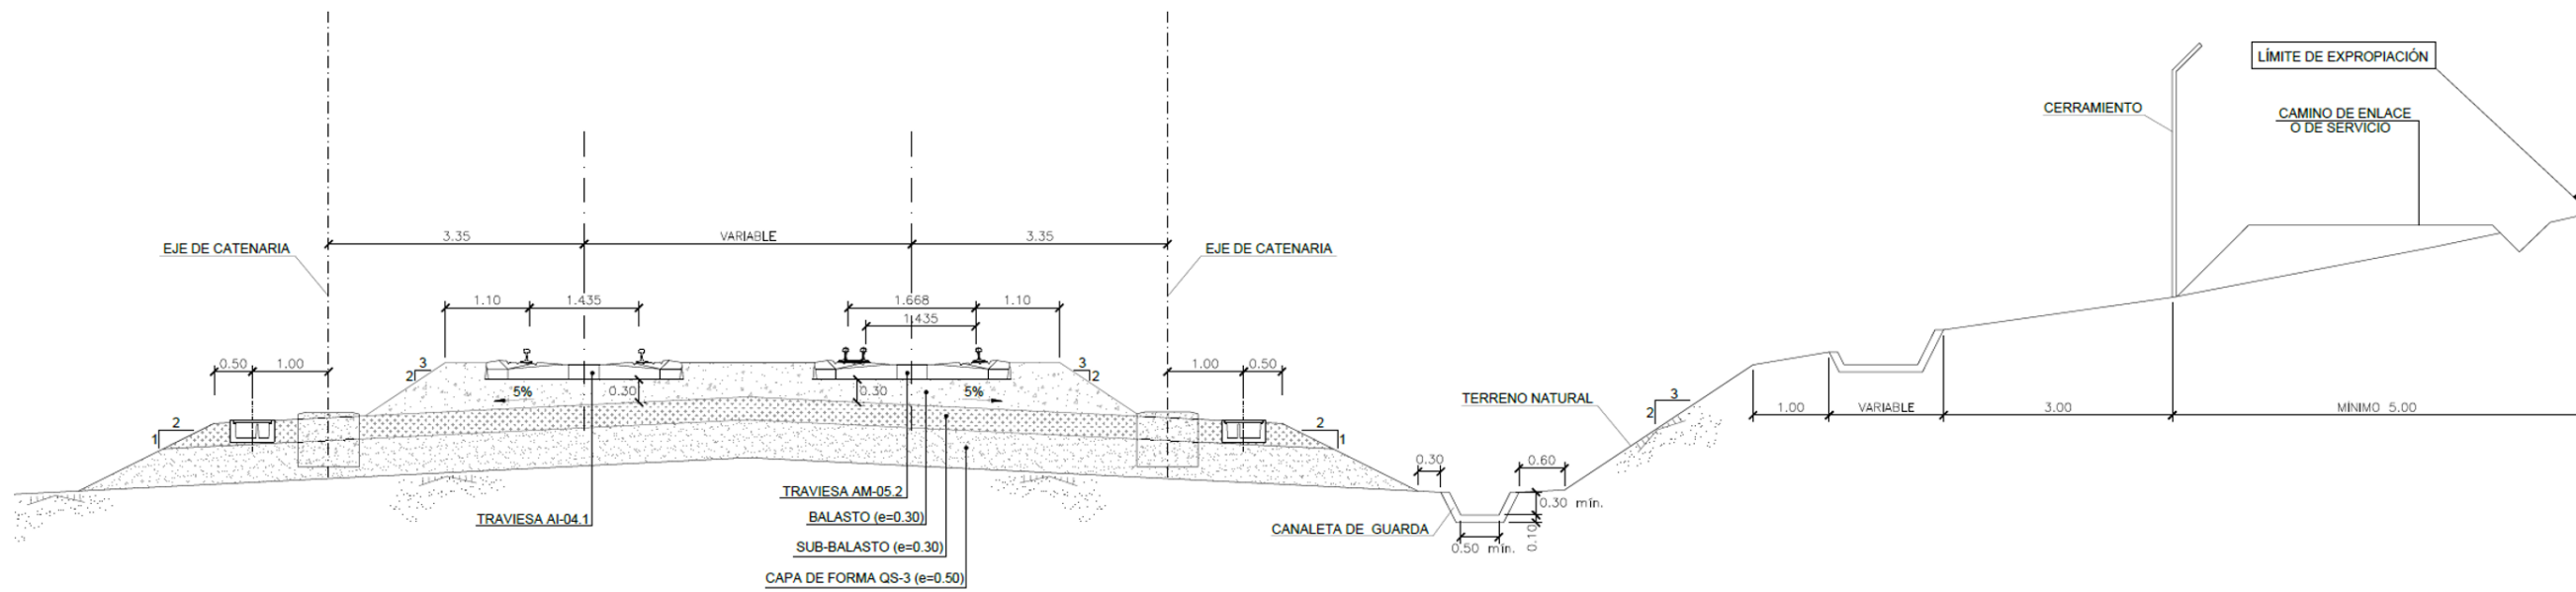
Sección tipo vía doble (ancho UIC + Mixto)
